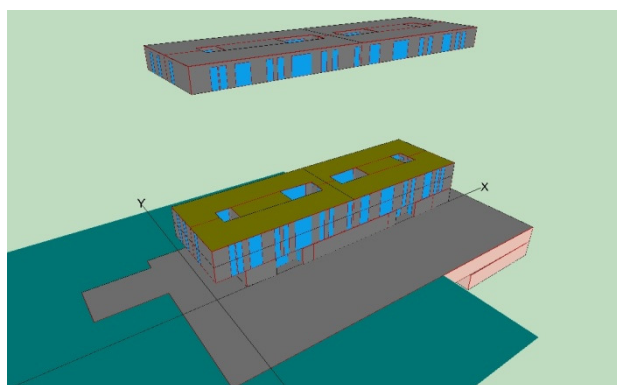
Edificio 44 habitatges. Sancho d'Avila
